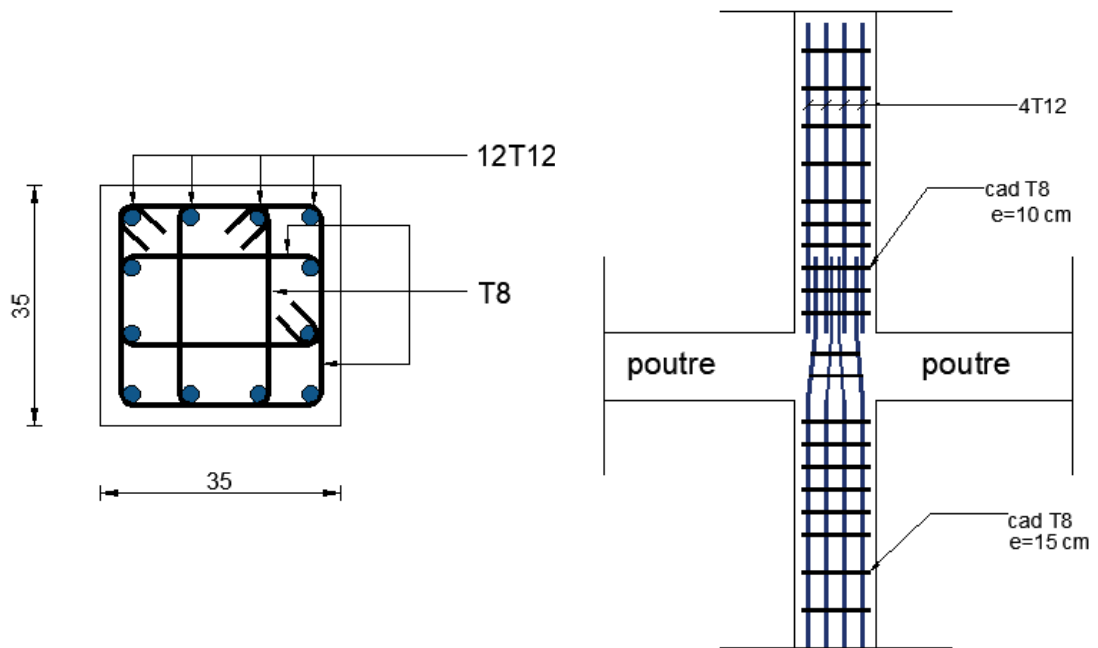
schéma de ferrailage des poteaux carrés de 6^{ème} et 7^{ème} étages
